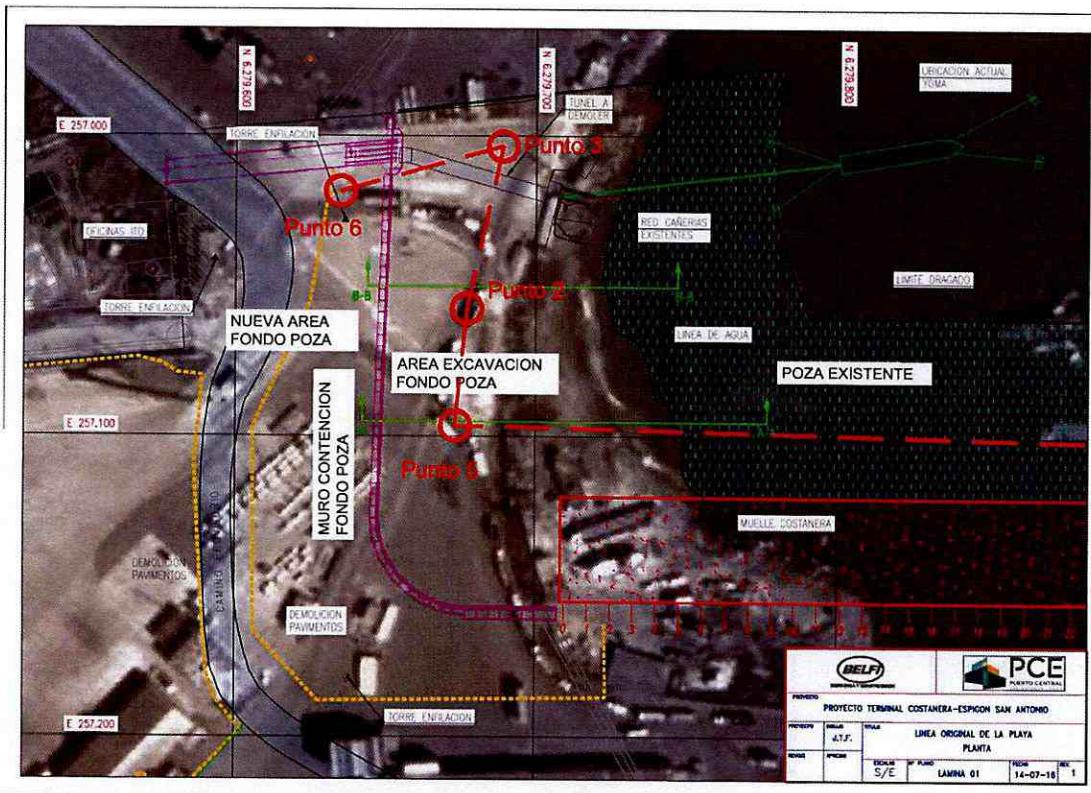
situación sin proyecto. Esta fotografía corresponde a la misma zona comprendida por la imagen N°1, pero con el detalle de las zonas donde se llevaron a cabo las excavaciones contempladas por la RCA N°51/2013. En efecto, la zona denominada "área excavación fondo poza" grafica el terreno superficial donde se llevaron a cabo las excavaciones de terreno superficial necesarias para la ejecución del proyecto Muelle Costanera San Antonio, y que luego fue dispuesto
